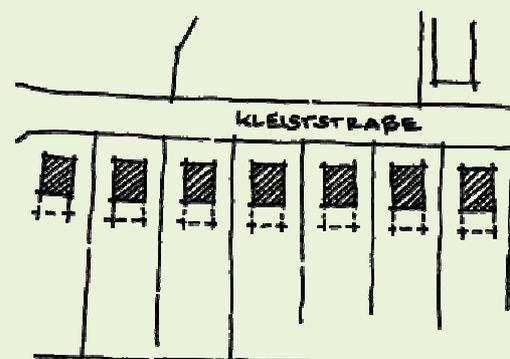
Lageplanskizze (Bestand mit Anbau Kleiststraße)
